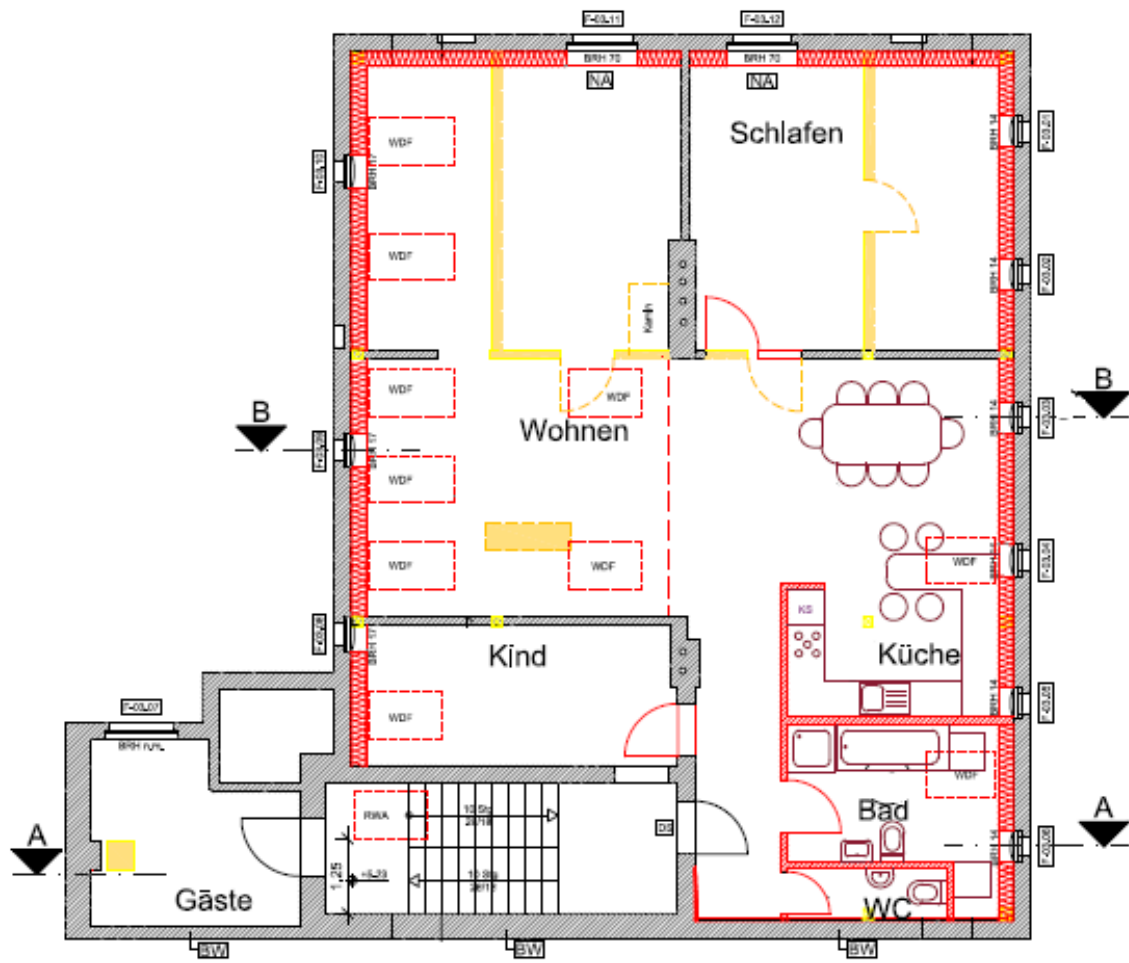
Grundriss Sanierung Dachgeschoss<sup>172</sup>
